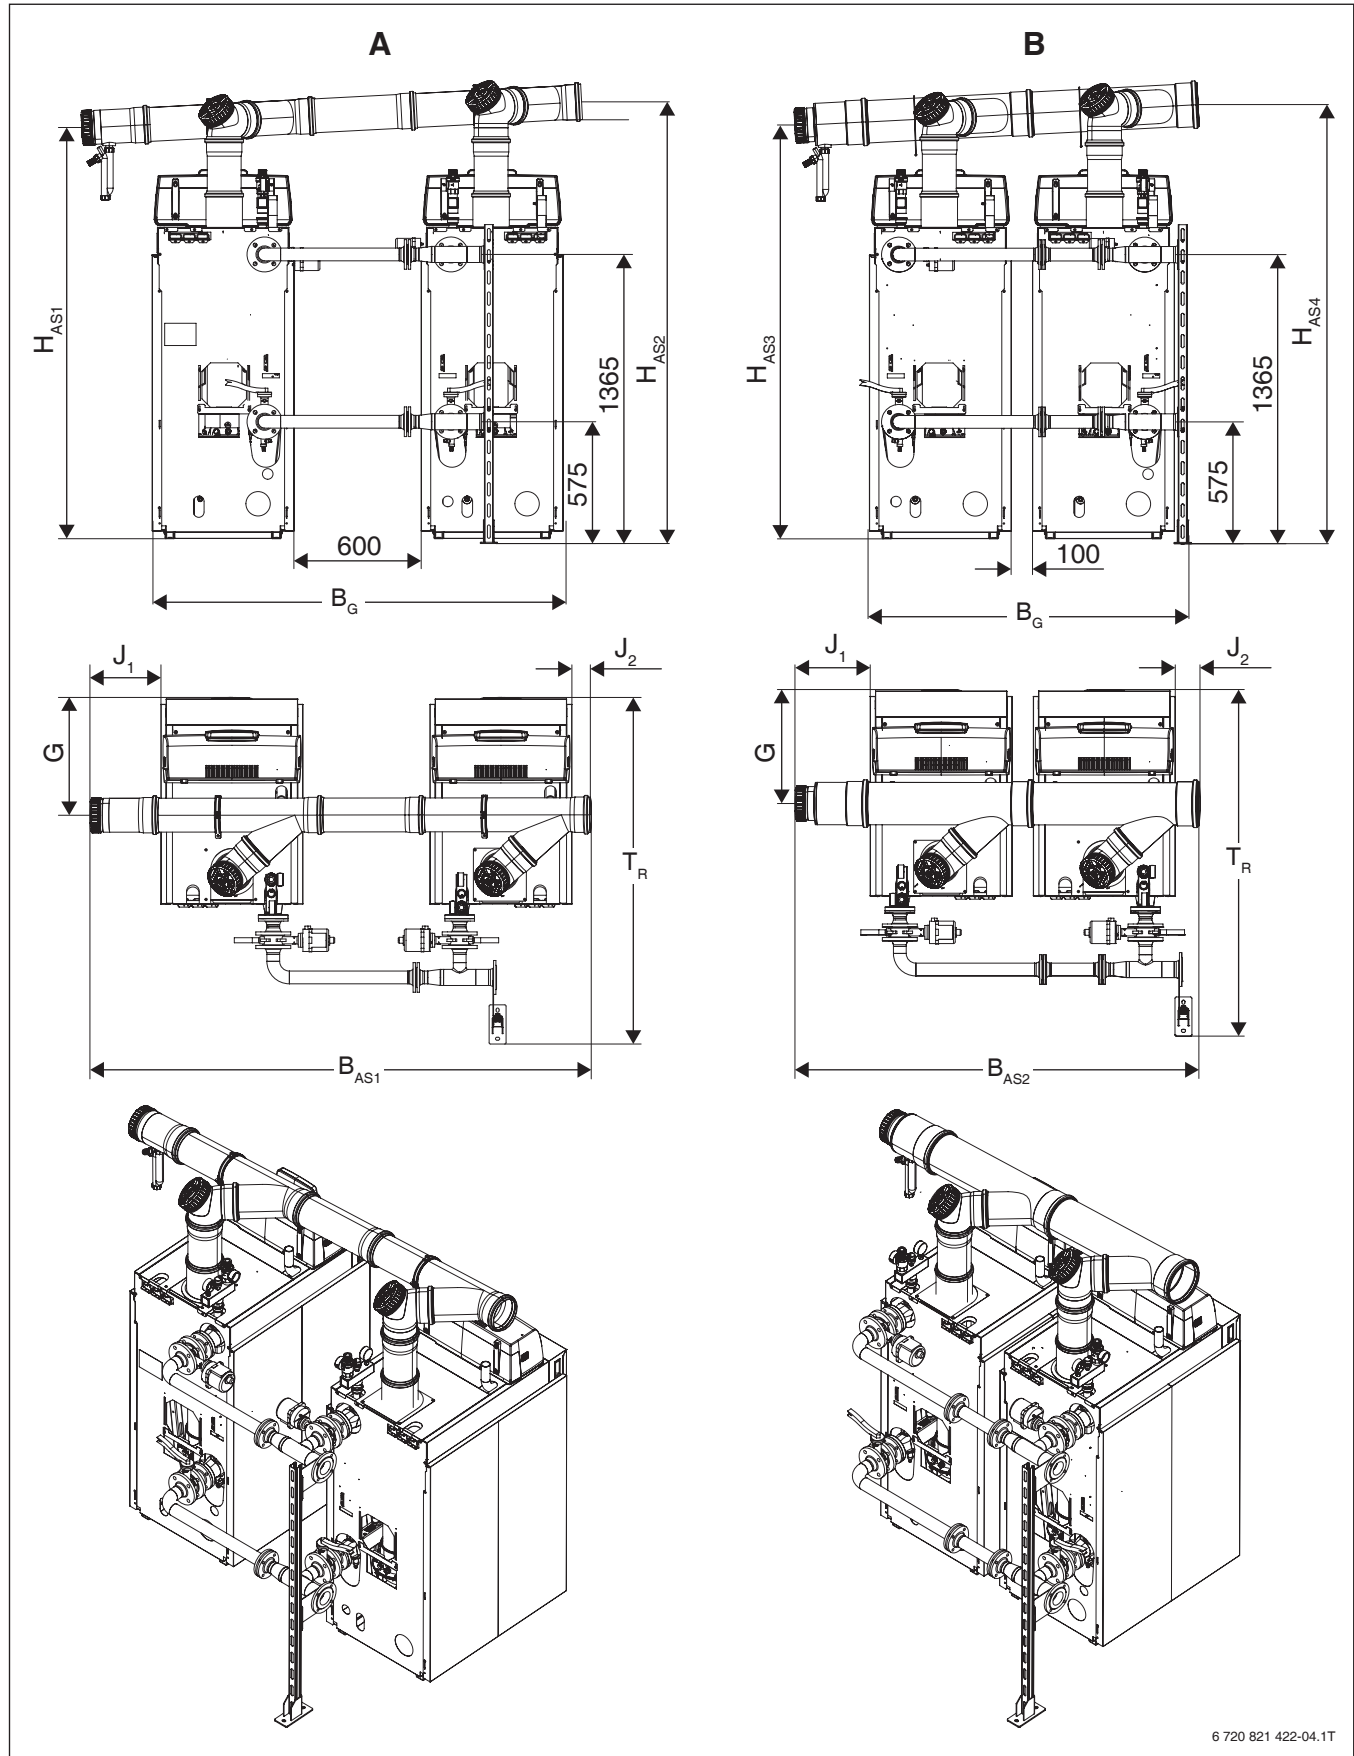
Abmessungen Logano plus KB372, 2 × 150 ... 2 × 300 kW – werkseitige 2-Kessel-Kaskade mit motorgesteuerter hydraulischer Absperrklappe (Maße in mm)
